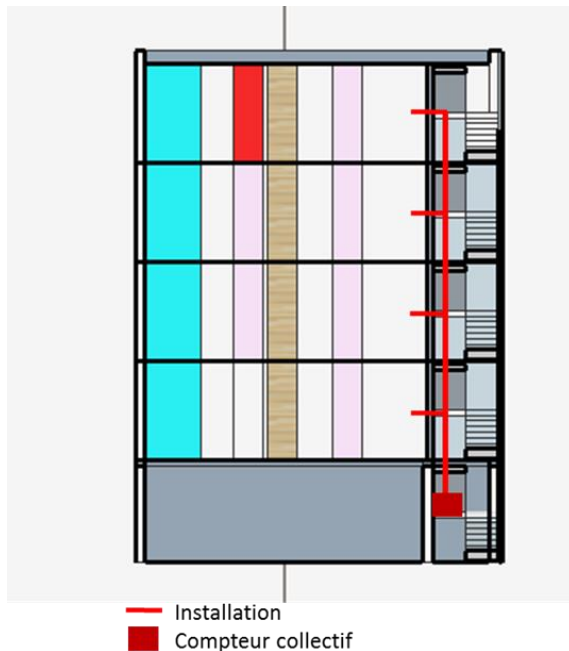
Coupe schématique de l'installation individuelle d'électricité dans l'immeuble
